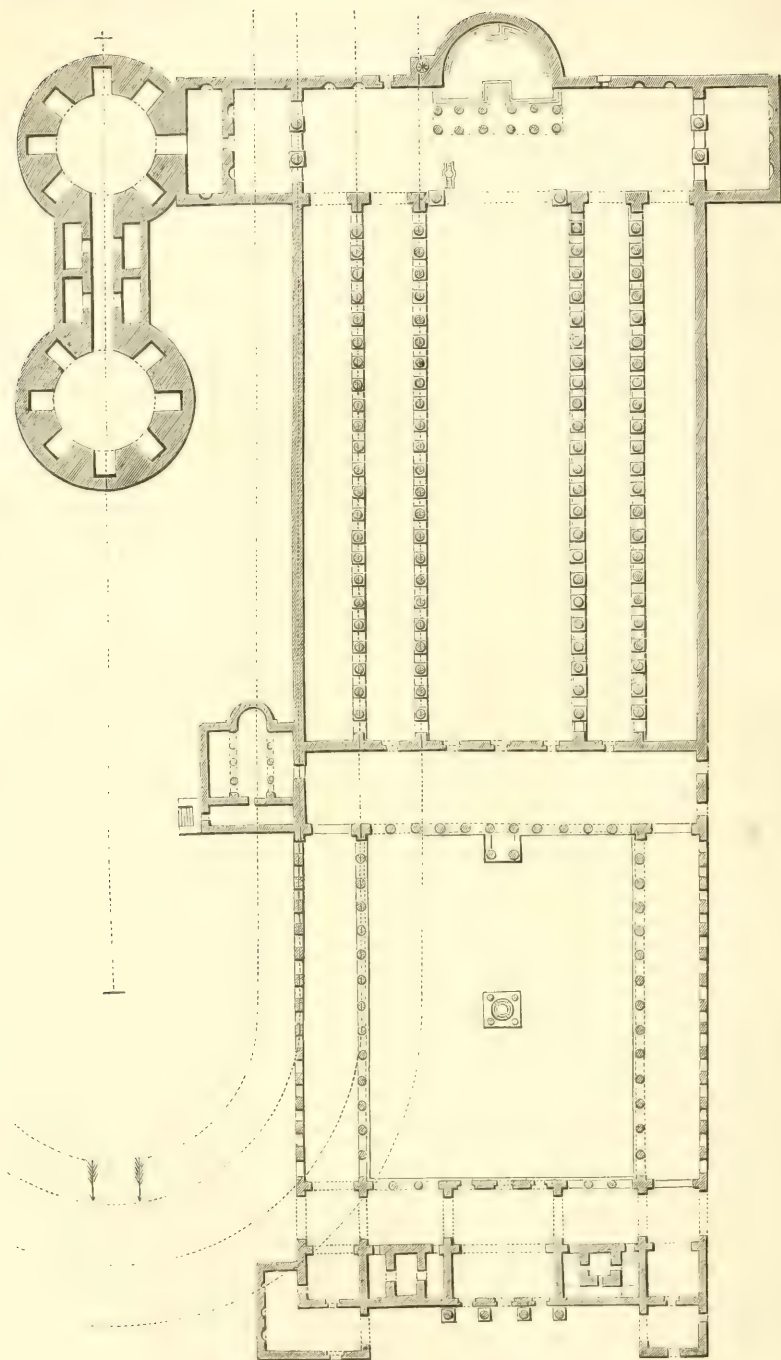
Grundriss der alten Peterskirche zu Rom.
